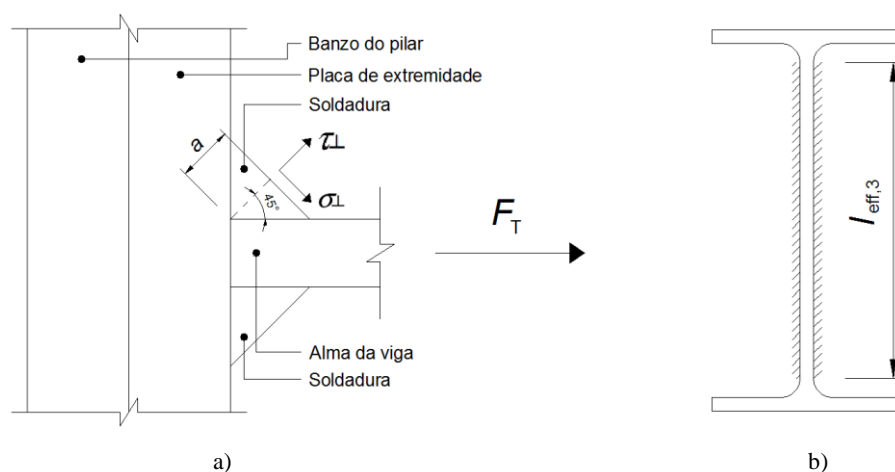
a) Corte (planta) longitudinal da alma da viga. b) Corte transversal da viga.
